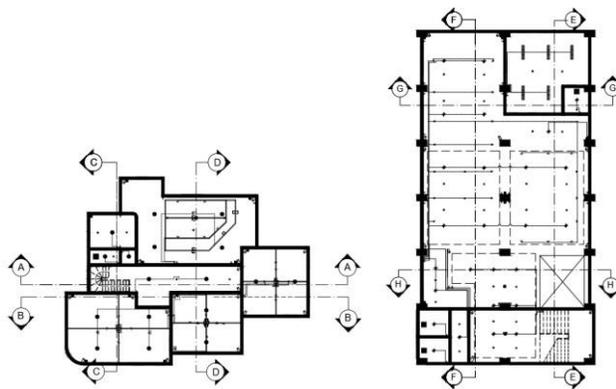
Ceiling Plan Denah Khusus Lantai 2
